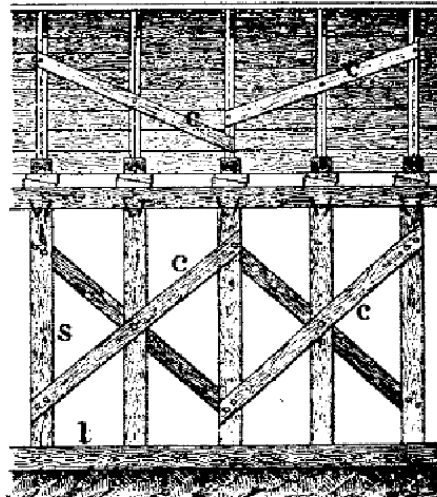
Выполнение деревянной опалубки под цилиндрический свод
